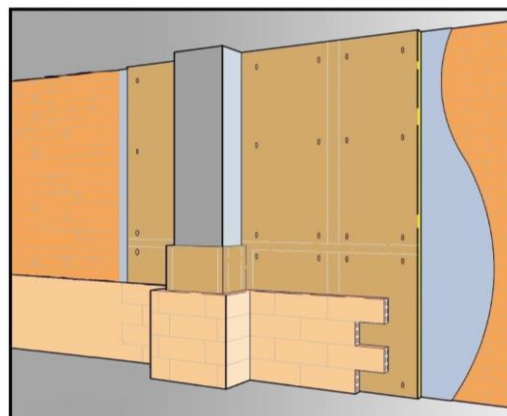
Cierre interior de las cámaras y emparchado de ladrillo de un pilar con inclusión de un aislante
